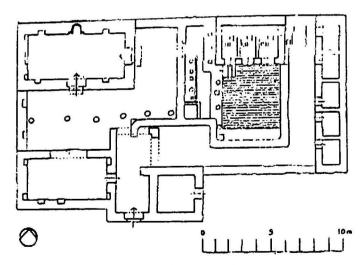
مسقط أفقي للمدرسة الأشرفية بمدينة تعز (عن الأكوع)
